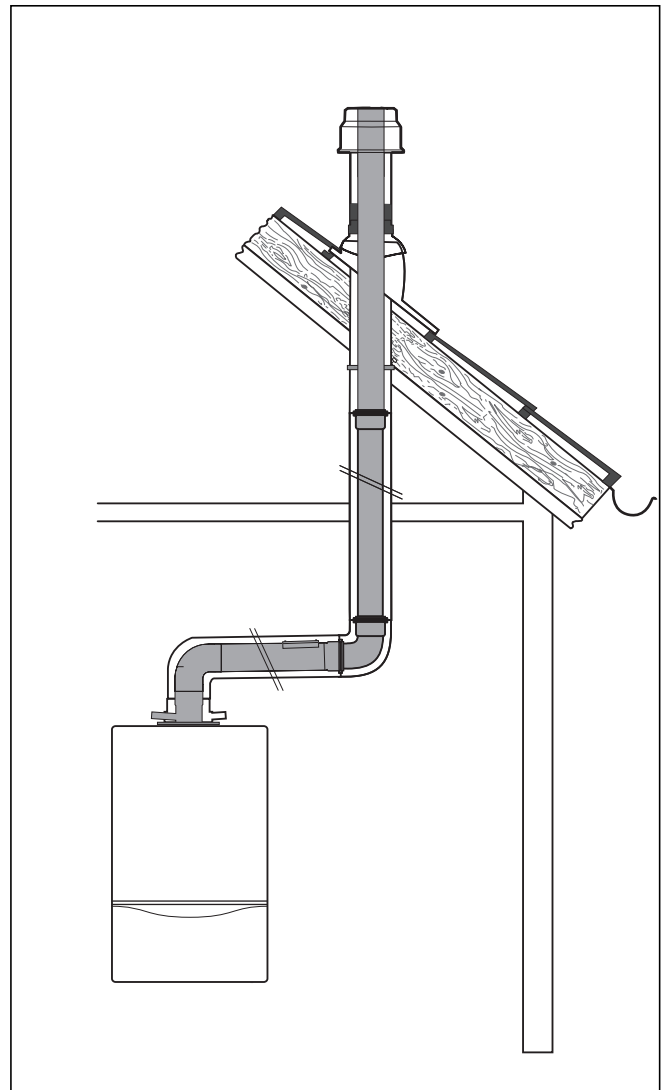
Montagebeispiel senkrechte Dachdurchführung mit Reinigungsöffnung
